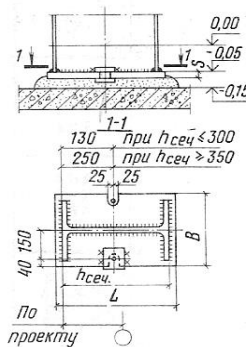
Узел крепления стойки фахверка к фундаменту
